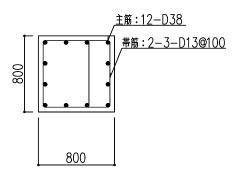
柱の配筋図(地下2階, X4/YP通り, 柱頭部)(単位:mm)
